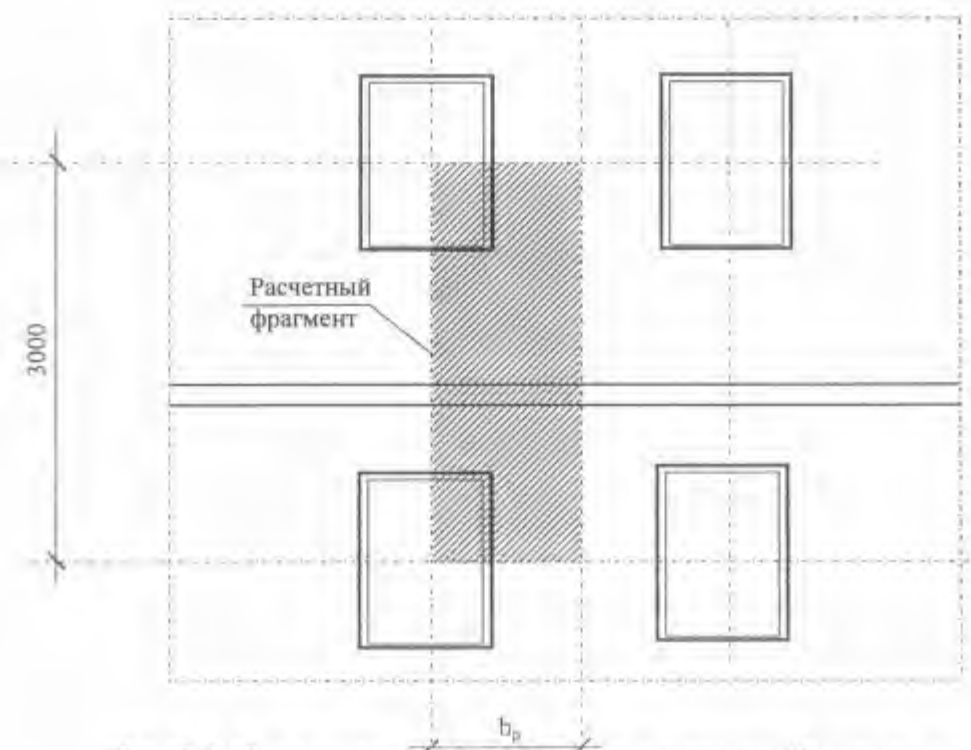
Расчетная схема фрагмента наружной стены здания для определения приведенного сопротивления теплопередаче участка с оконными проемами (вид со стороны помещения)
